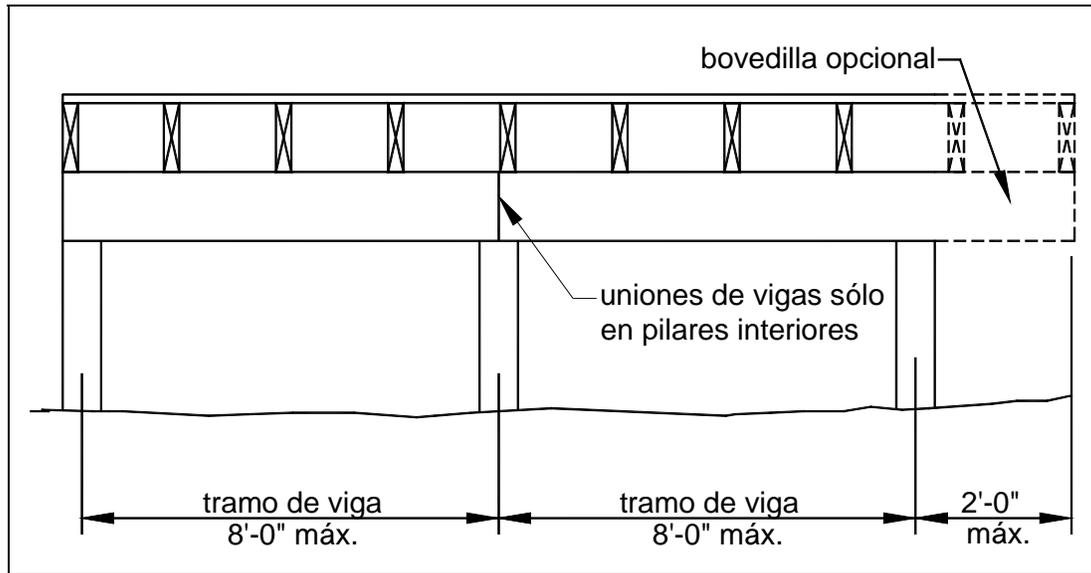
TIPOS DE TRAMOS DE VIGAS
